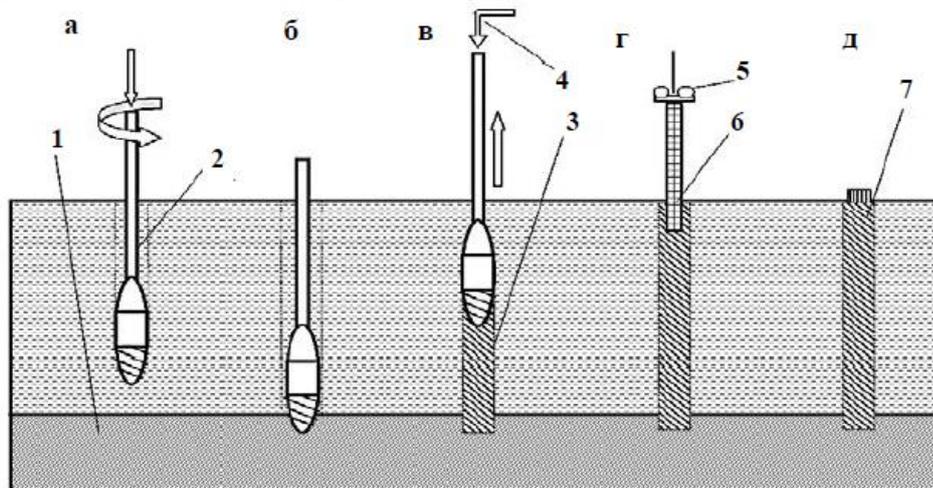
Послідовність влаштування палі ущільнення: 1 – щільний ґрунт; 2 – обсадна труба; 3 – свердловина, що заповнюється бетоном; 4 – подавання бетону бетононасосом; 5 – вібратор, що підвищується на стрілу крана; 6 – арматурний каркас; 7 – палі в ґрунті
